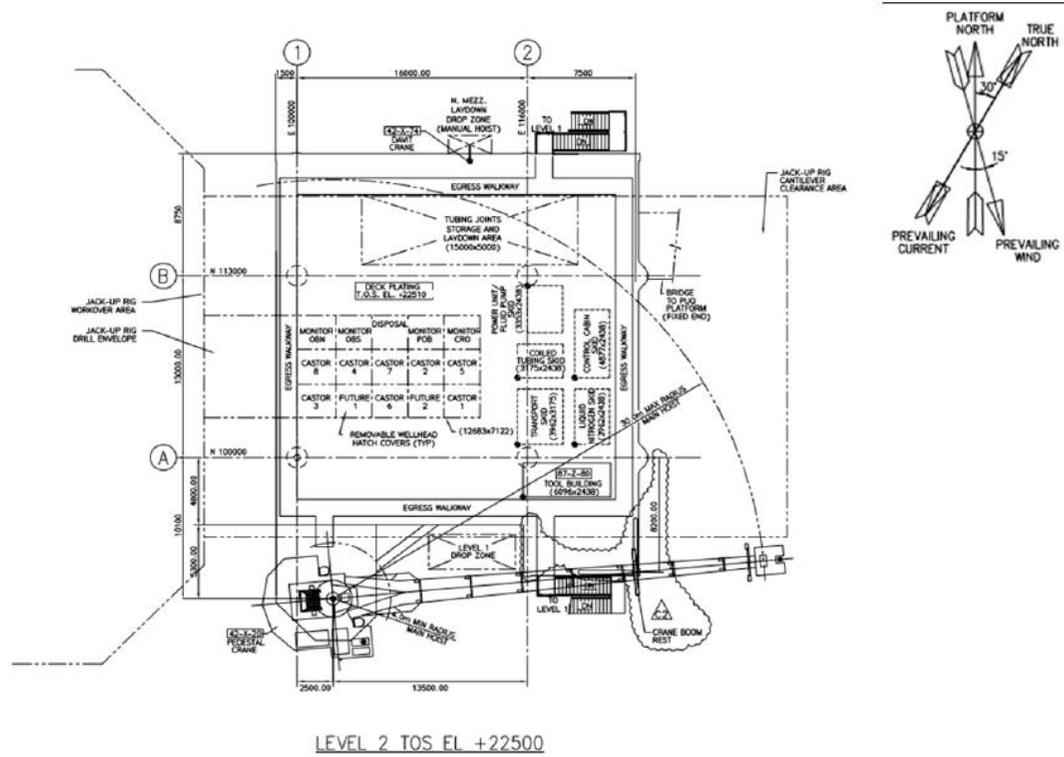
Vista en planta de la Plataforma de pozos (WHP)
